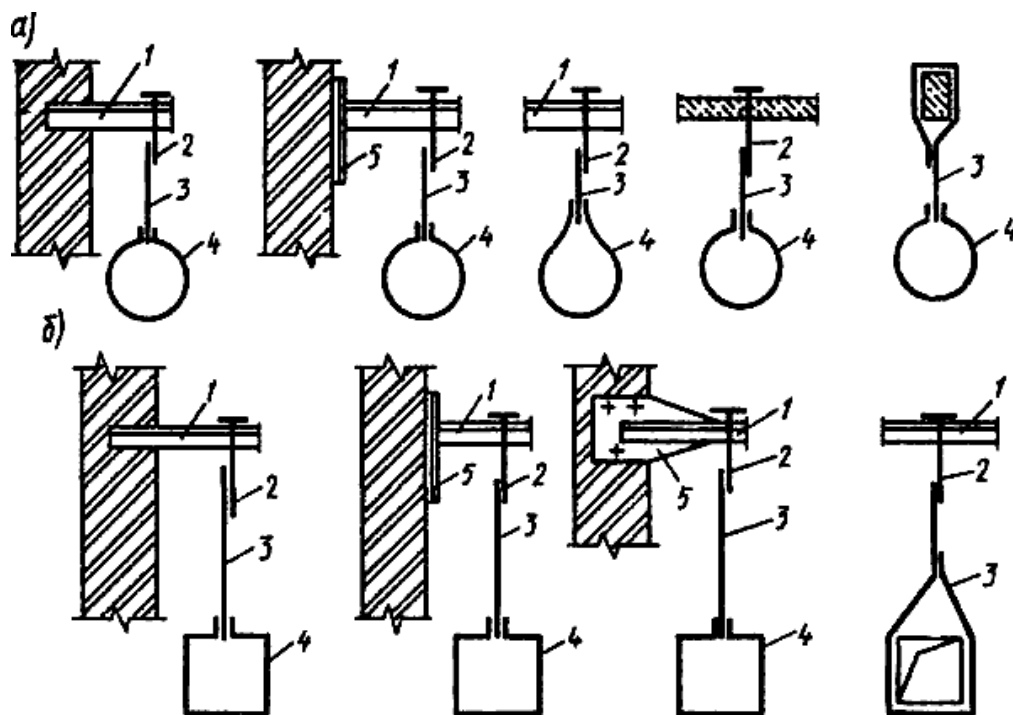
Конструкция крепления стальных горизонтальных воздуховодов:
